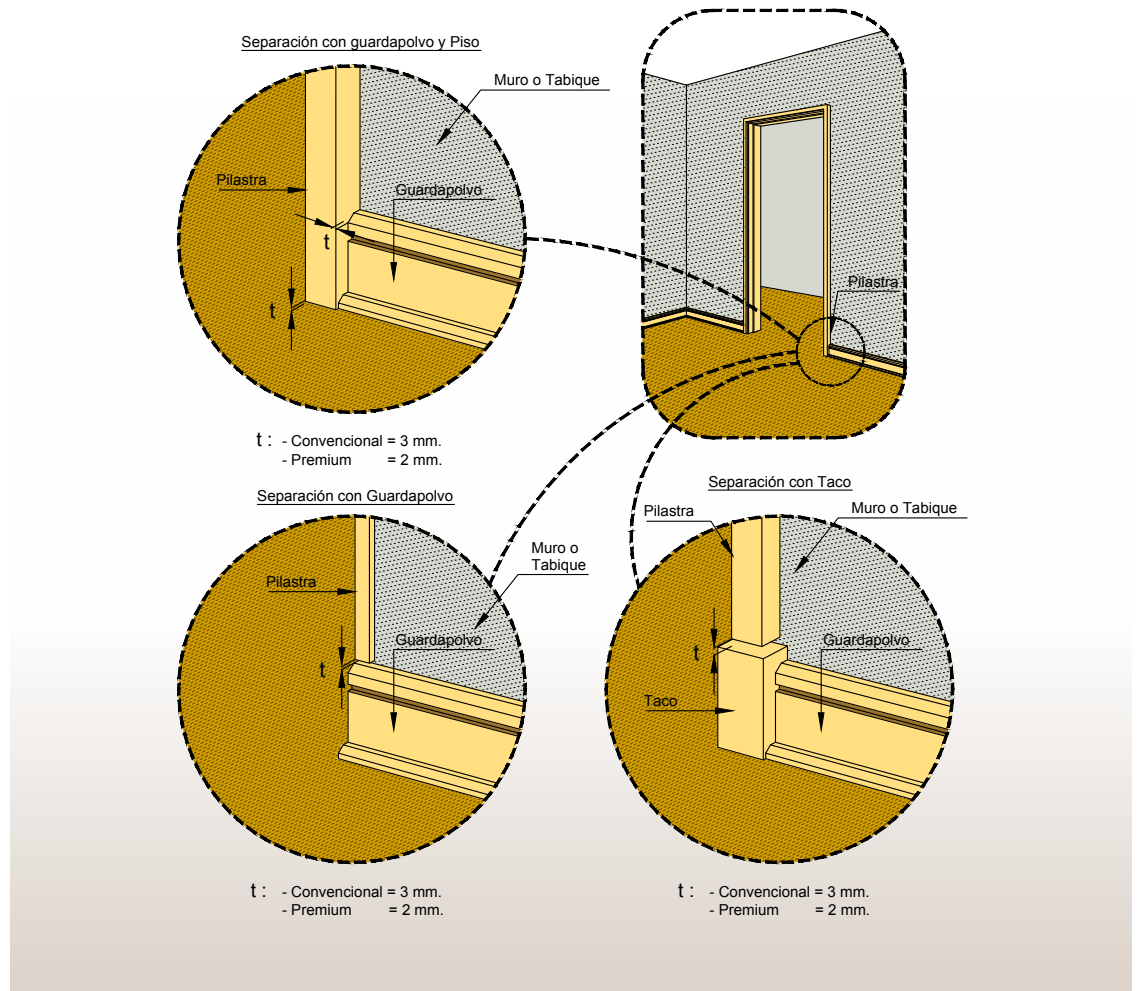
SEPARACIÓN DE PILASTRAS A ELEMENTOS
